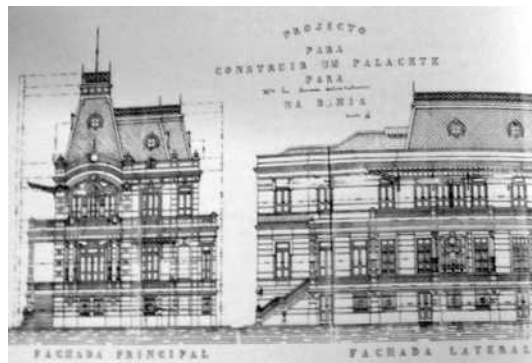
Projeto original para as fachadas do palacete. Fonte: JORDAN, 2006, p. 70.
